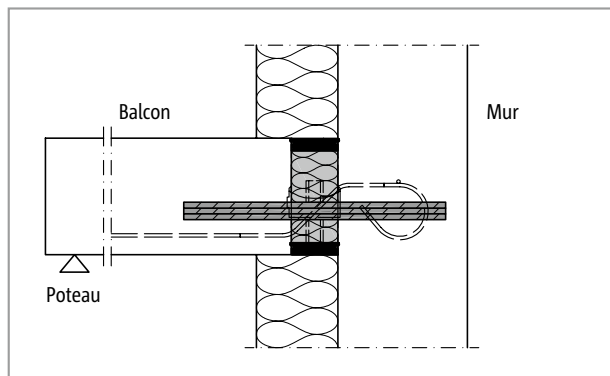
Schöck Isokorb® T Type CQ, CH-VV-NN : raccord à un mur de béton armé avec isolation externe
